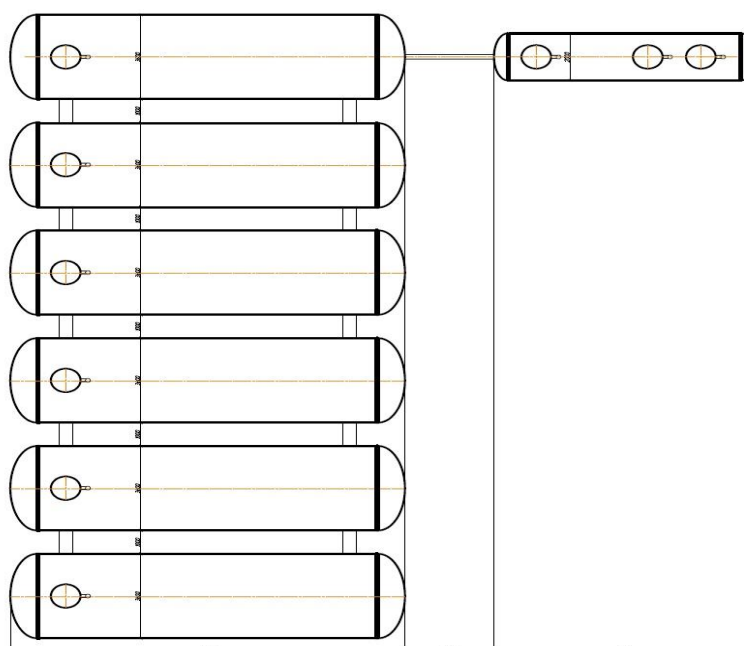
Габаритные размеры. Схема-накопительная.
